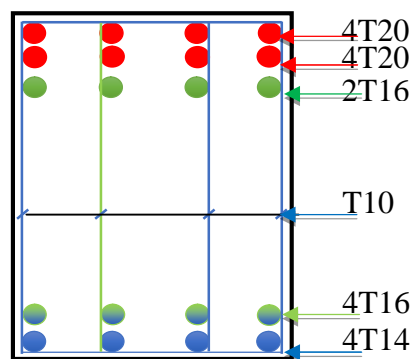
Ferrailage de la poutre de libage (sens longitudinal et
